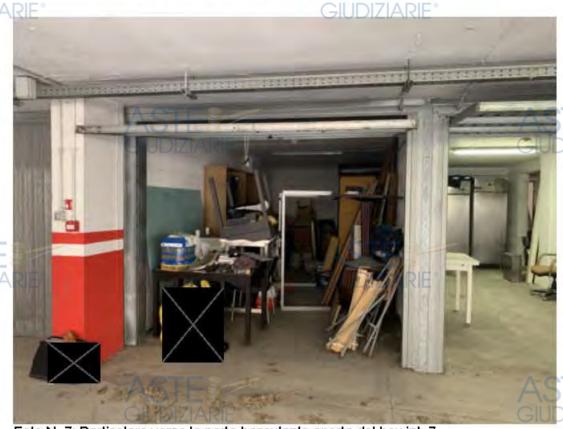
Particolare verso la porta basculante aperta del box int. 7
